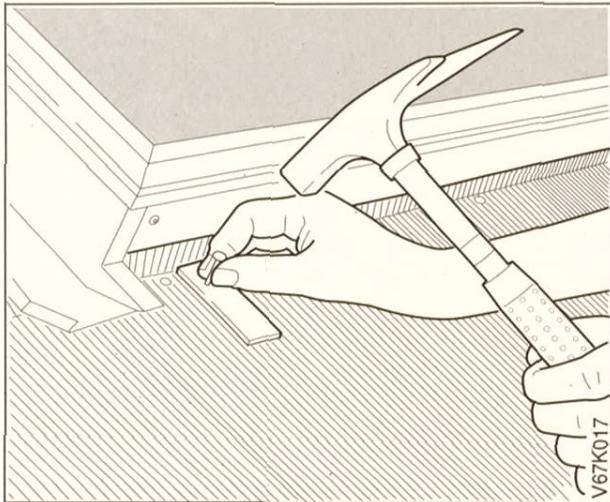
Auf der Bleischürze 3 Blechlaschen pro Kollektor möglichst weit oben befestigen.
